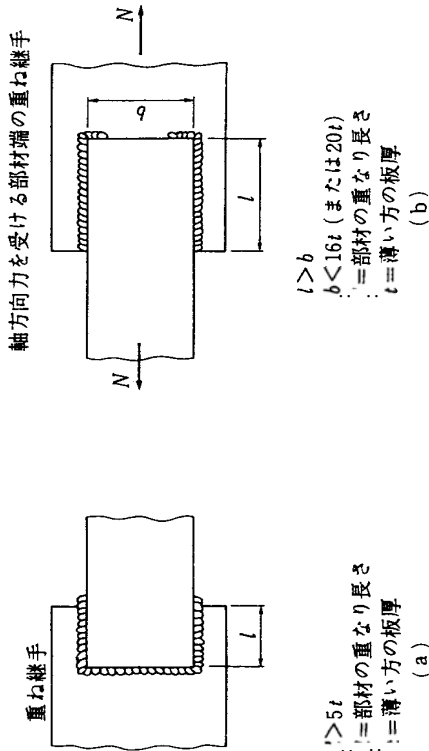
重ね継手のすみ肉溶接
